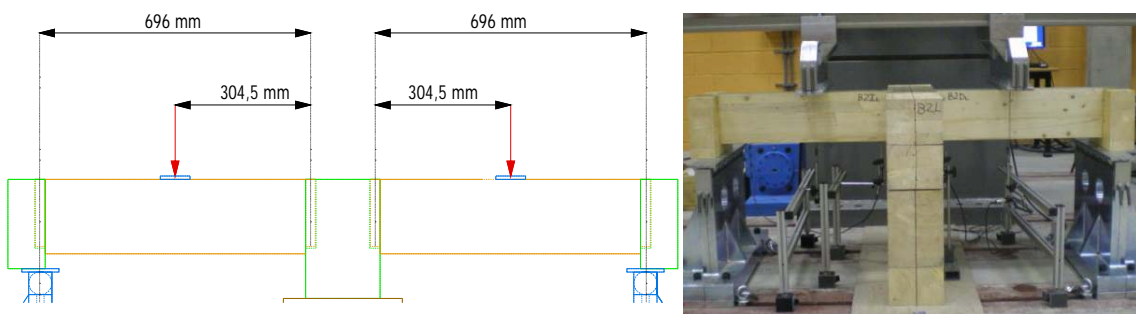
Distancia entre ejes de los apoyos y distancia de punto de aplicación de la carga al eje de la espiga del apoyo sobre la viga central
